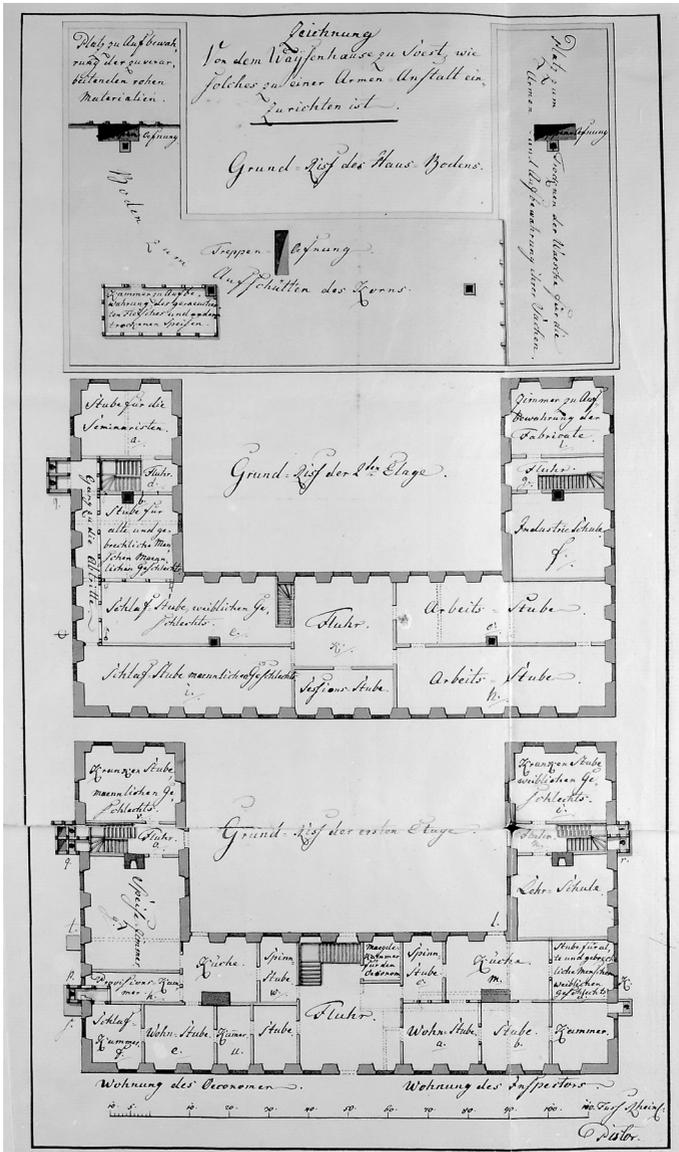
Plan des Waisenhauses (ca. 1808)
